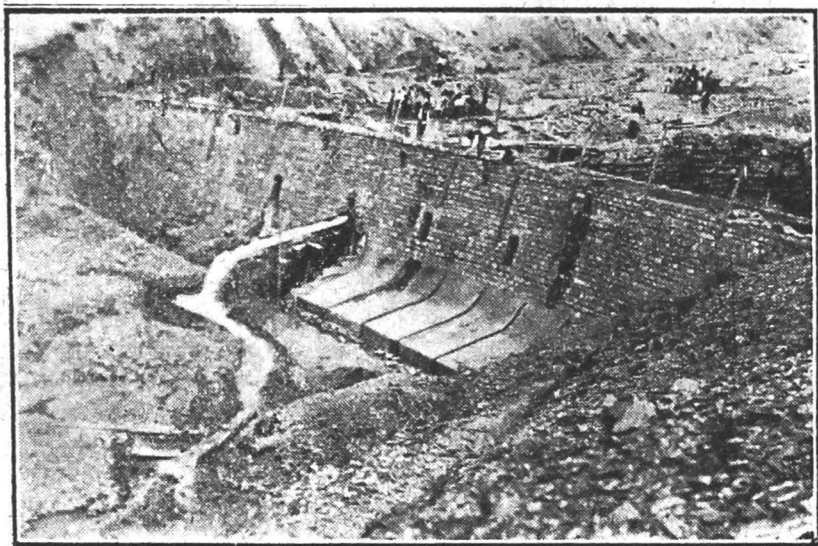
Baraj intermediar pe valea Bogdan, construit în beton cu parament de piatră și cu pintelul de blocuri de beton, construite pe loc și divizate în tronsoane.
